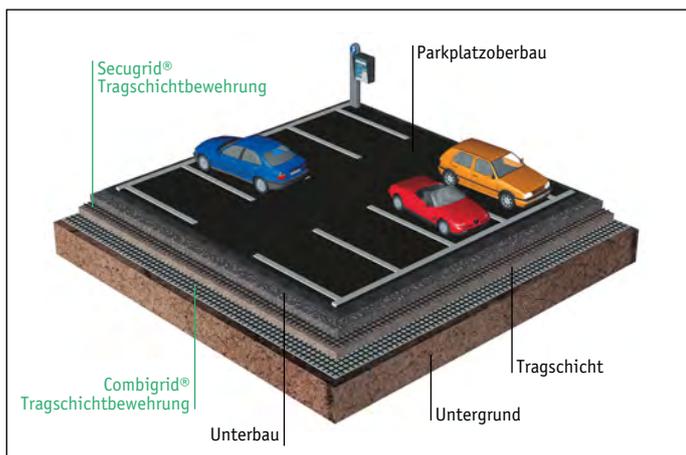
Tragschichtbewehrungen bei Parkplätzen
